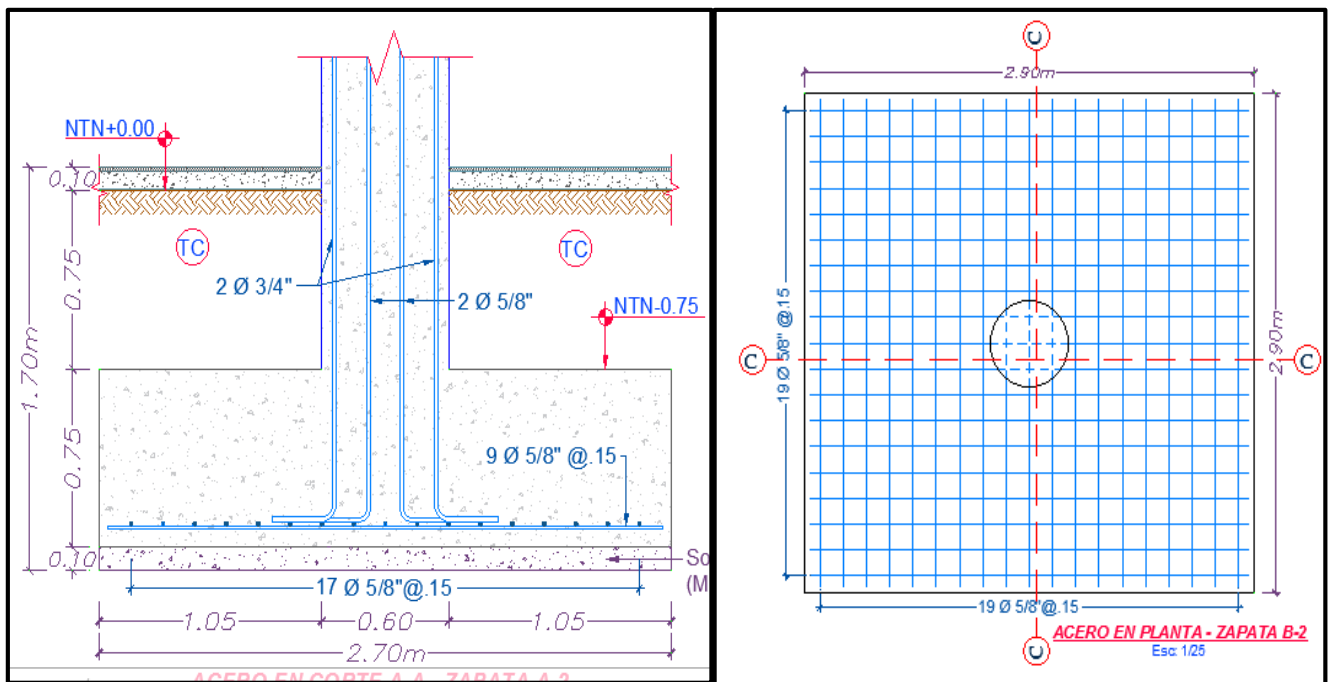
Detalle de zapata aislada en corte y planta respectivamente.
